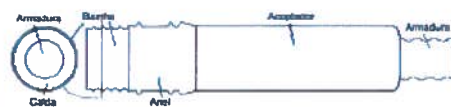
Esquema do sistema de proteção contra a corrosão com pormenor da zona de ligação das armaduras das ancoragens em estudo.
